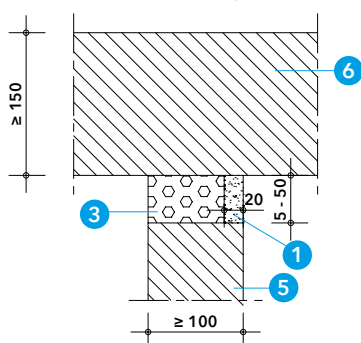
Detail E - pohled shora - svislá spára ve stěnové konstrukci EI 90
